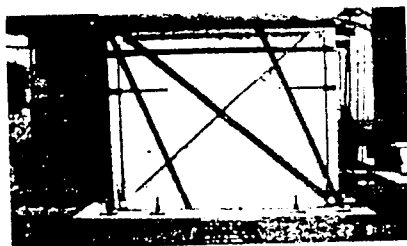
Rehabilitación de un muro de mampostería usando bandas de fibras de carbono.
